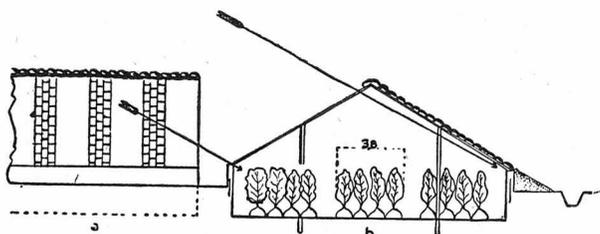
Croquis d'un hangar d'hivernage pour les régions à hivers rigoureux. a — versant sud de la toiture ; b — coupe transversale. (D'après Alexandrov [2].)
